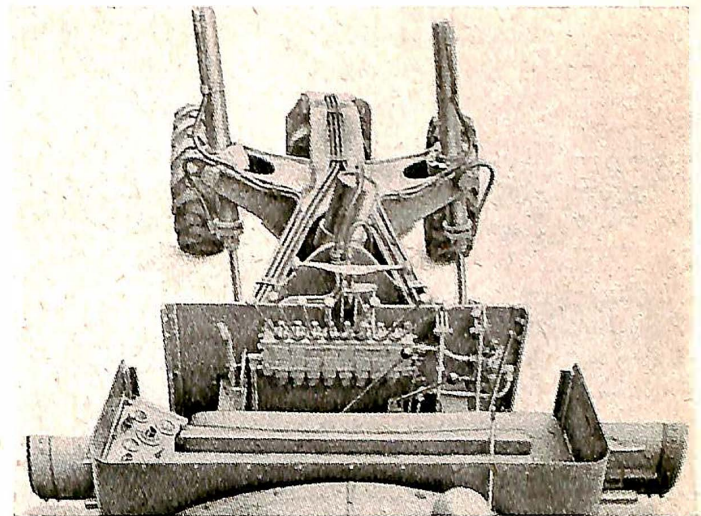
Instrumentbordet på motor grader med hydraulisk manøvrering. Håndtaket foran de 7 hendler med kule på betjener styringen.
